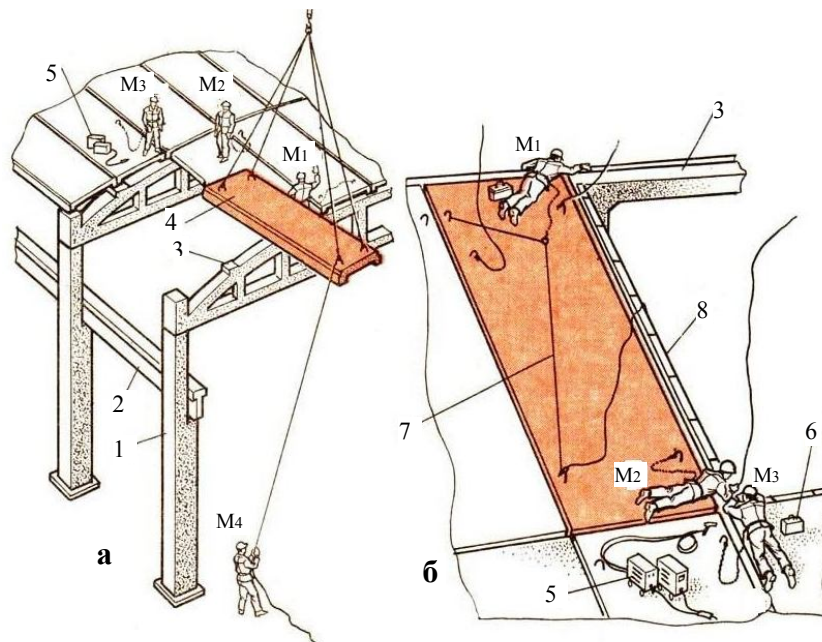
Розподільний метод монтажу залізобетонних плит покриття: а – піднімання плити; б – знімання розпірки між фермами; 1 – колона; 2 – підкранова балка; 3 – ферма; 4 – плита покриття; 5 – зварювальний апарат; 6 – скринька із інструментом; 7 – страхувальний канат; 8 – розпірка; М1-М4 – монтажники
